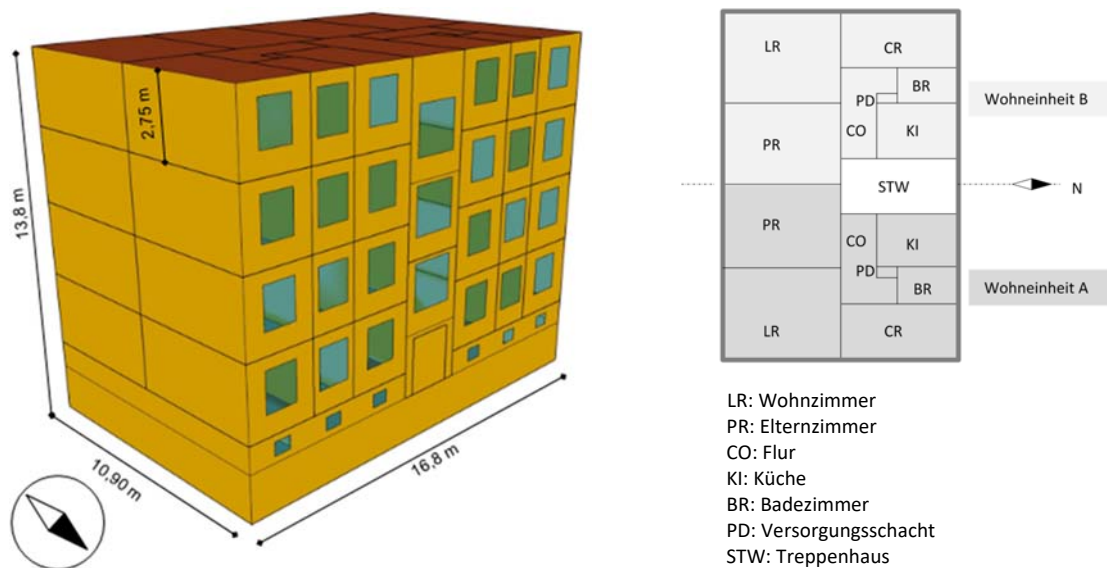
3D-Modell des untersuchten Gebäudes mit Außenmaßen (links) und Grundriss der Wohnungen (rechts)
